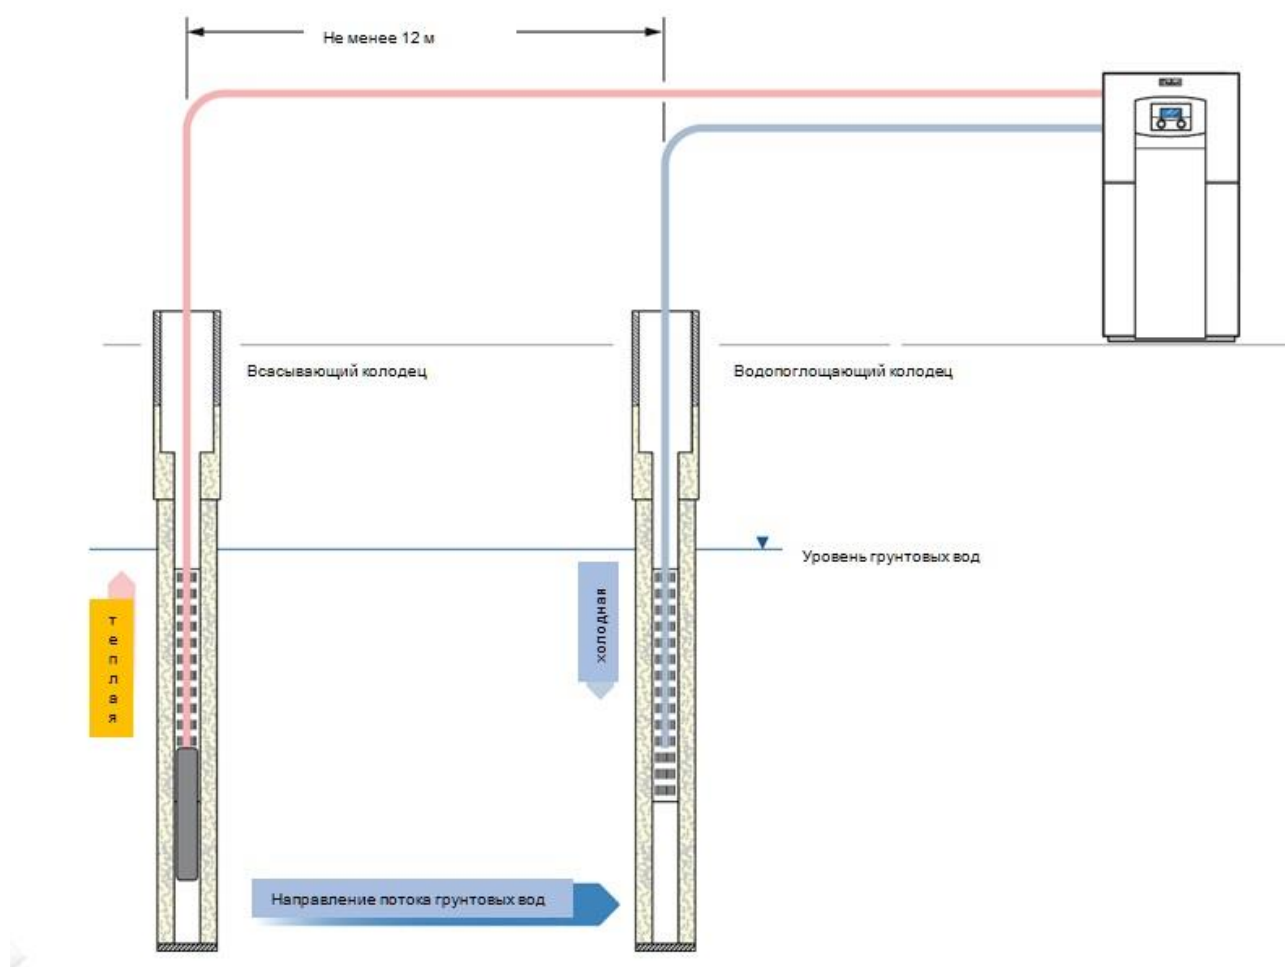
Схема открытой системы использования низкопотенциальной тепловой энергии грунтовых вод
